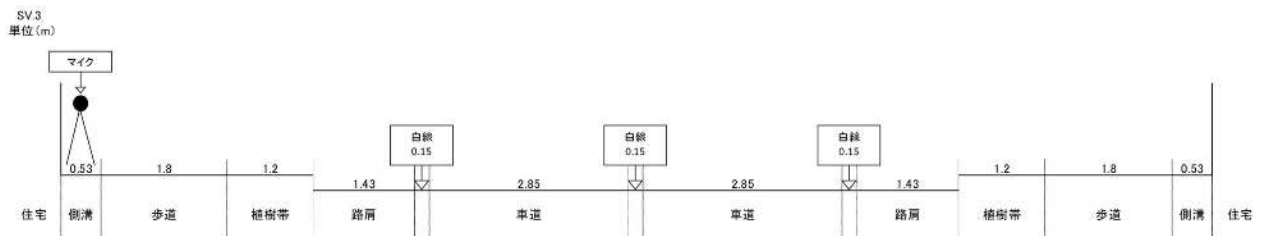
(1) 道路構造断面図 (SV. 3)
